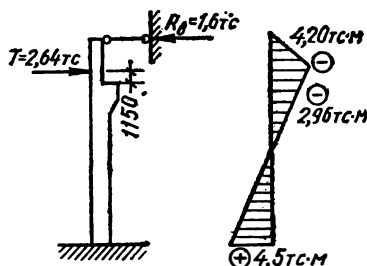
Расчетная схема и эпюра M от поперечного торможения крана для колонны по оси A .
